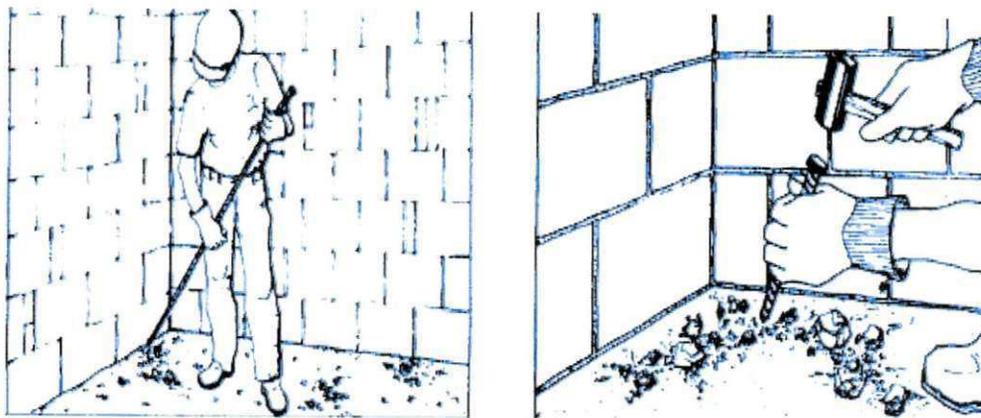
Remoção de detritos aderidos à laje utilizando um vanga ou ponteira, picão e marreta.
